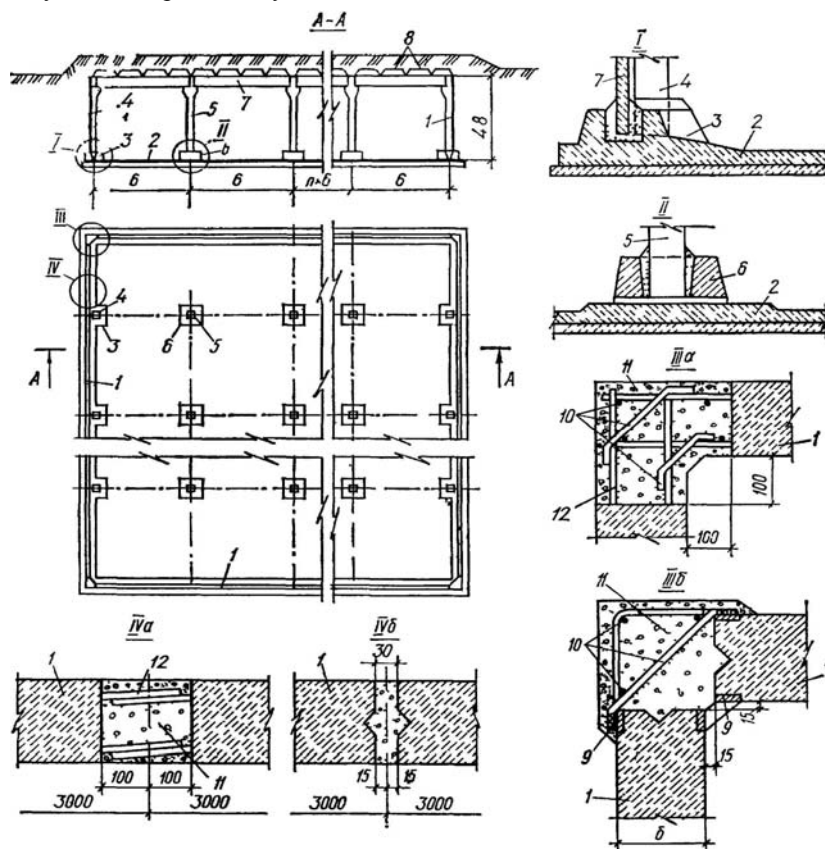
Прямоугольный резервуар из унифицированных сборных железобетонных элементов:
